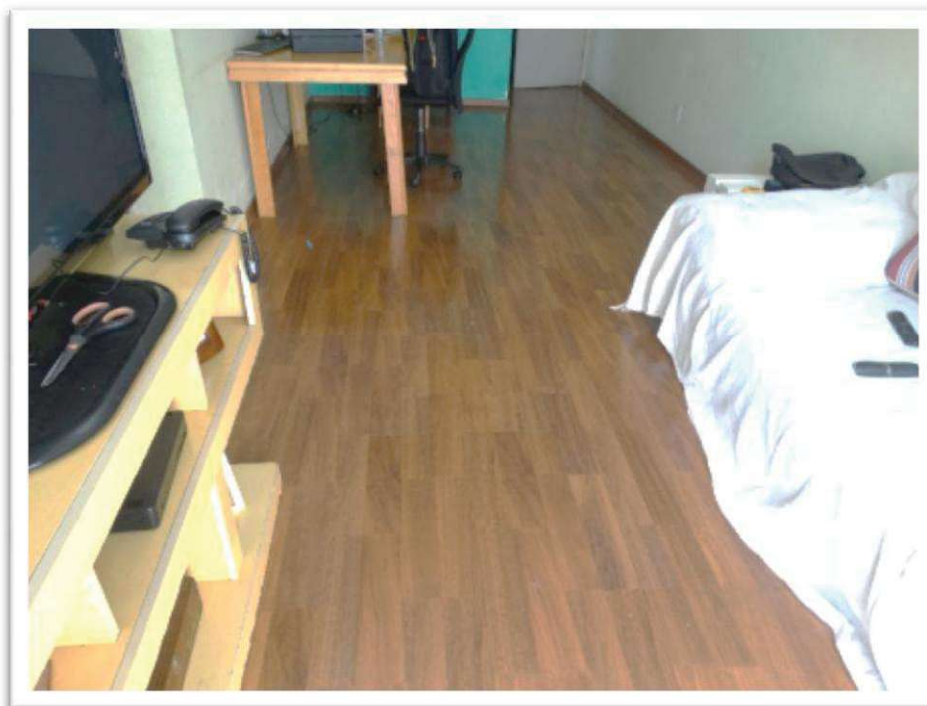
Vista parcial da varanda do apartamento nº 13 do Edifício Parpan objeto da presente vistoria.
